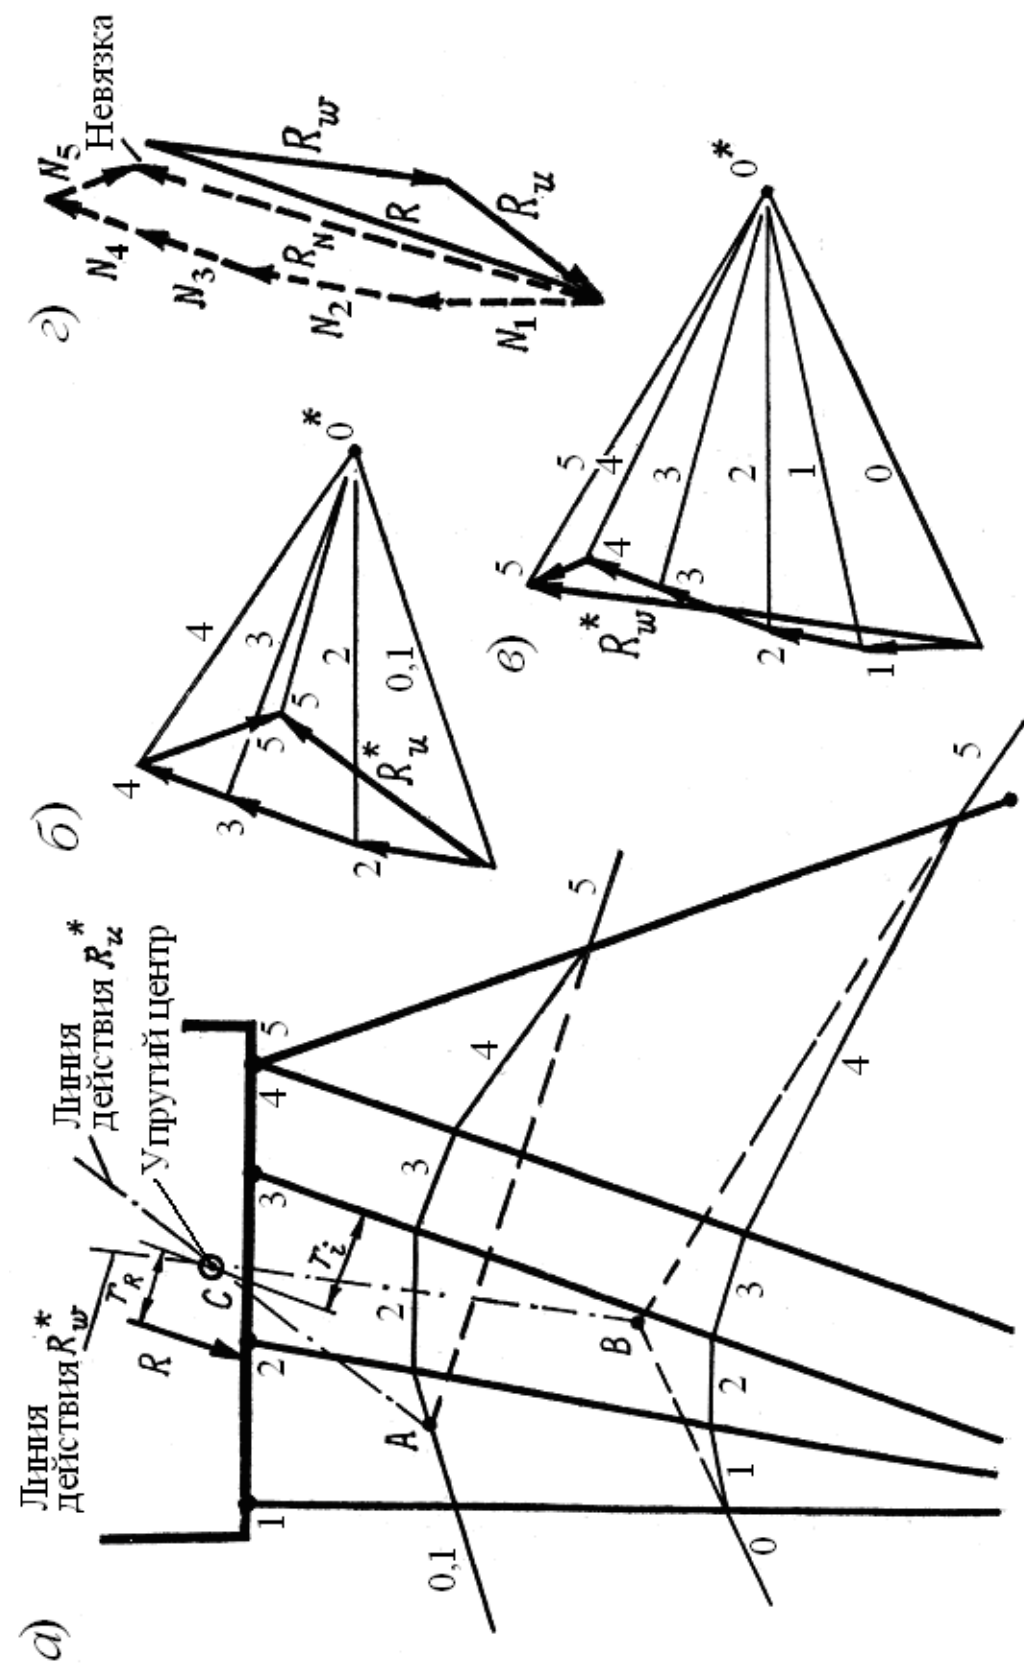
К определению усилий в сваях при жестком ростверке:
